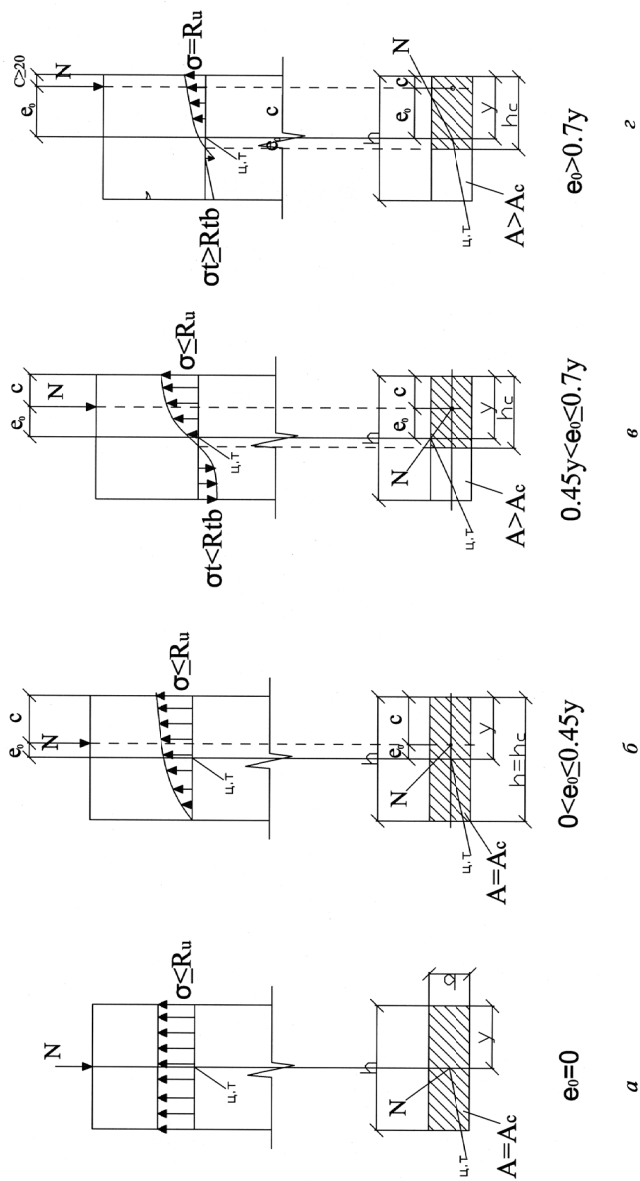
Эпюры напряжений при внецентренном сжатии кладки
